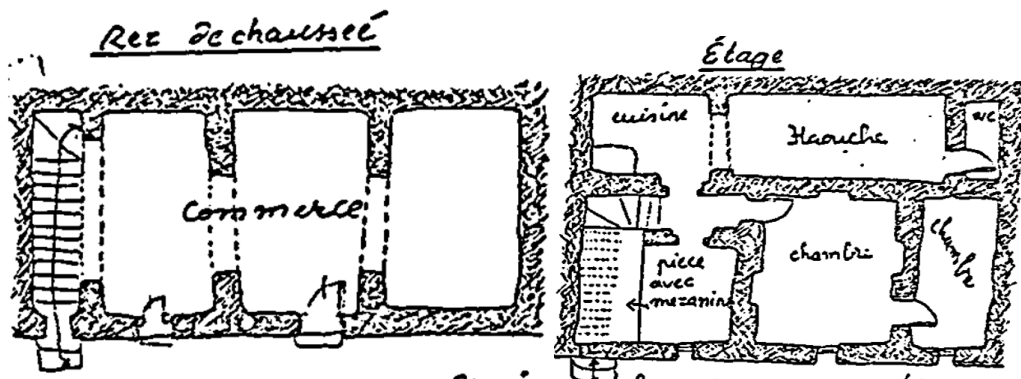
plan d'une maison traditionnelle a commerce (source : mémoire revalorisation d'un ancien quartier a Laghouat, Takhi.B)
